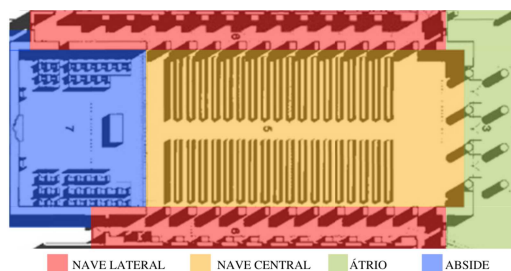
Divisão de ambientes em Planta Baixa Abadia Cisterciense;
